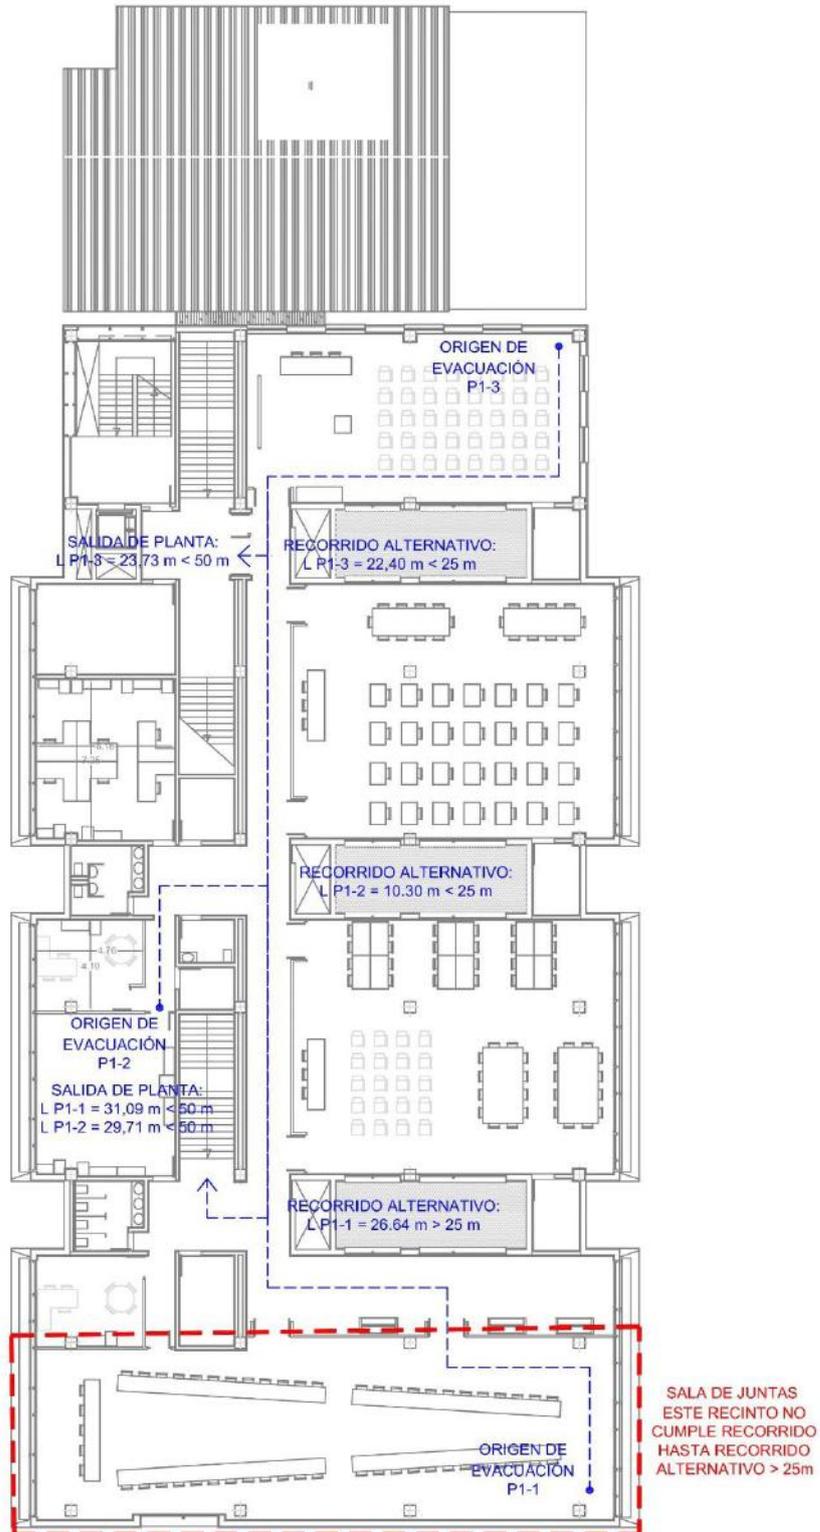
Cumplimiento Longitud Recorridos de Evacuación Planta Primera. Figura extraída del plano 41.
